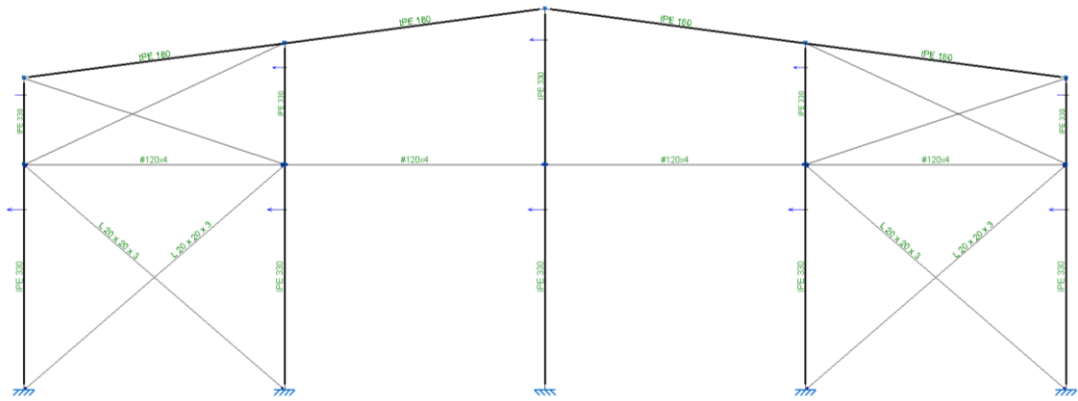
Pórtico de fachada de la nave principal con detalle de los perfiles
